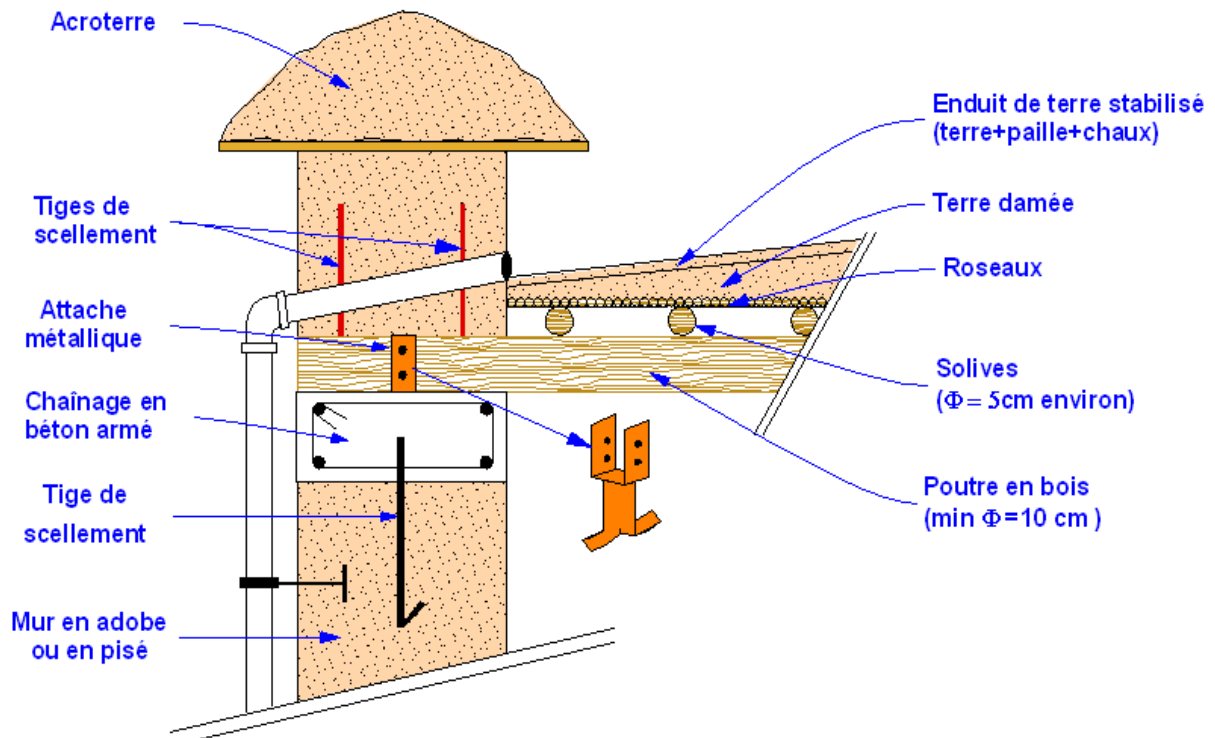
Chaînage horizontal en BA ; Toiture traditionnelle et attaches mur - chaînage et plancher-chaînage
